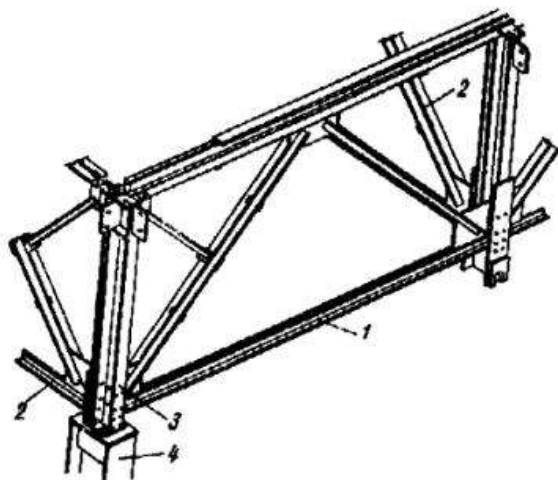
Узлы примыкания стропильных и подстропильных стальных ферм к опорной стойке и установка на оголовок колонны:
